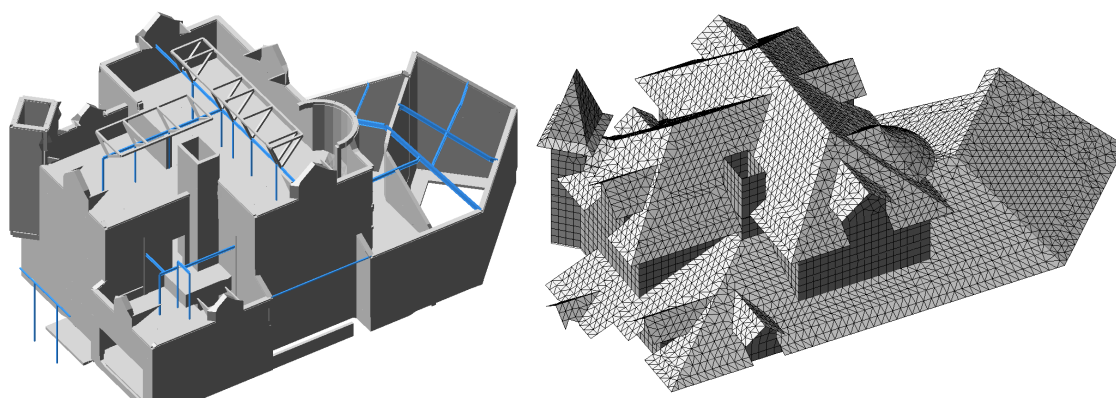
Расчетная схема основных несущих элементов стропильной системы и покрытия
